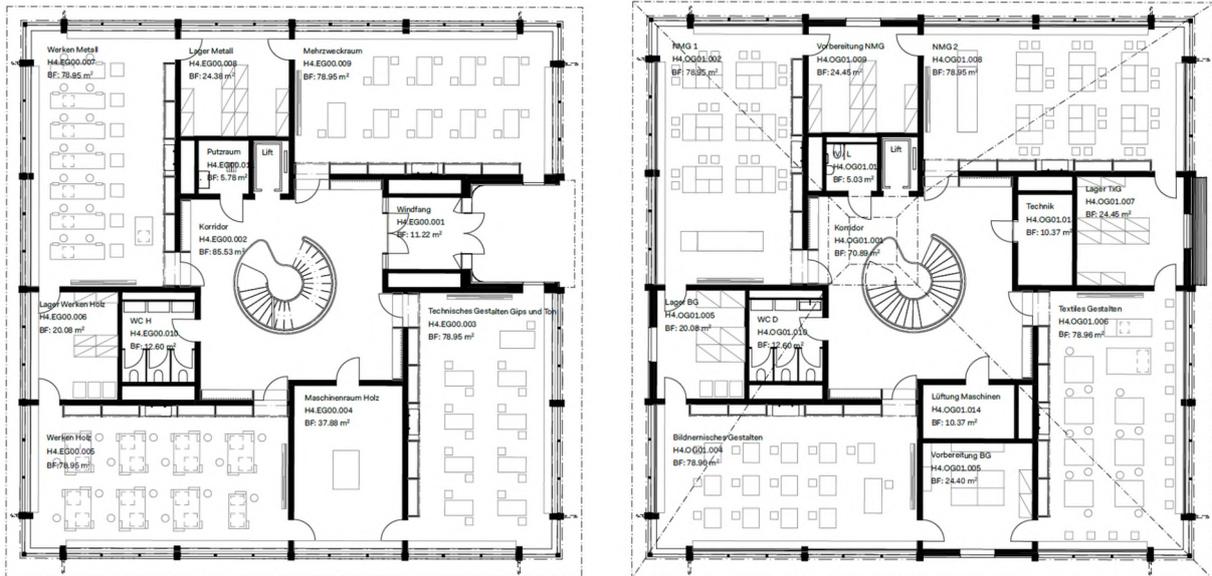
Erweiterungsneubau – Grundrisse Erdgeschoss und Obergeschoss
